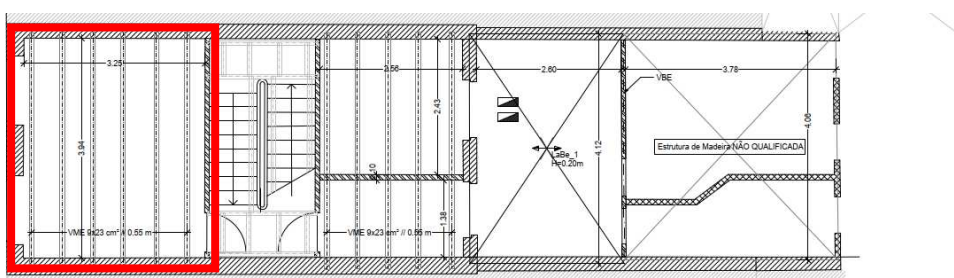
Pavimento tipo marcado a vermelho (Planta estrutural do piso 2)
